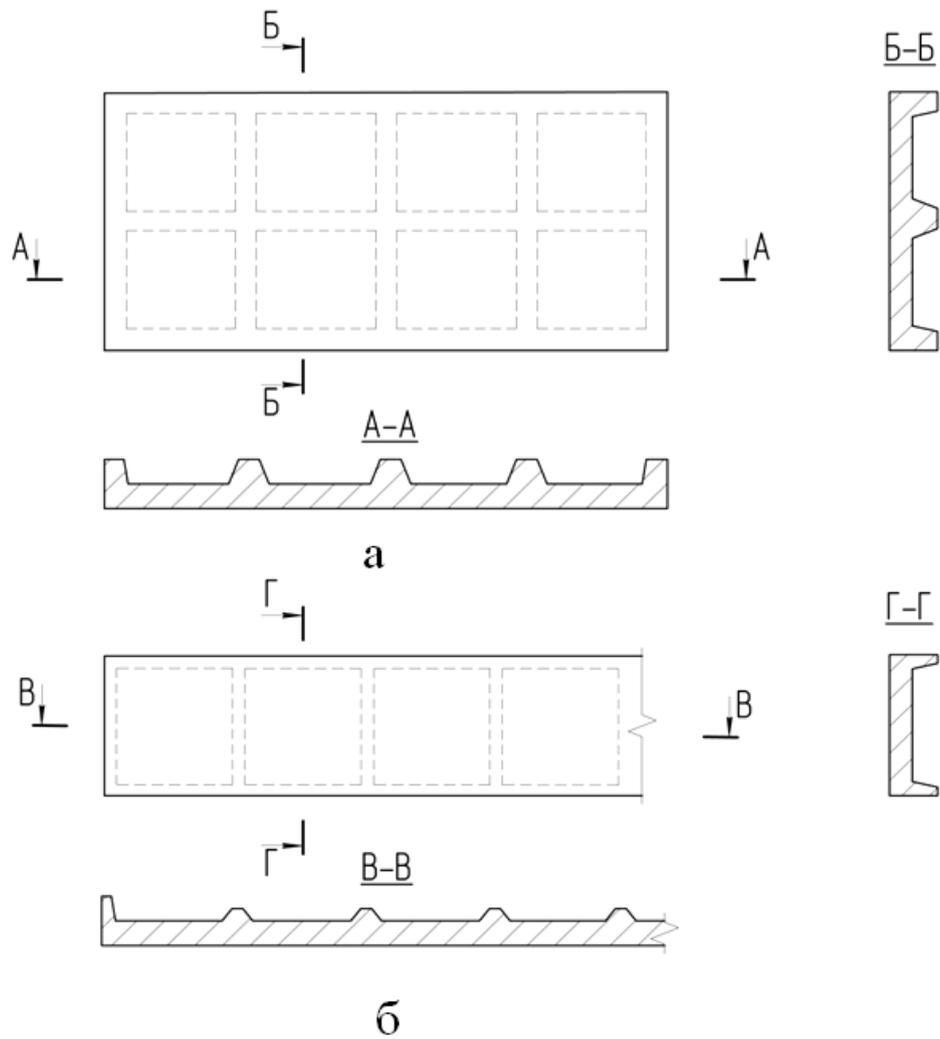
Неутепленные железобетонные ребристые стеновые панели: а – панель длиной 6 м; б – панель длиной 12 м
